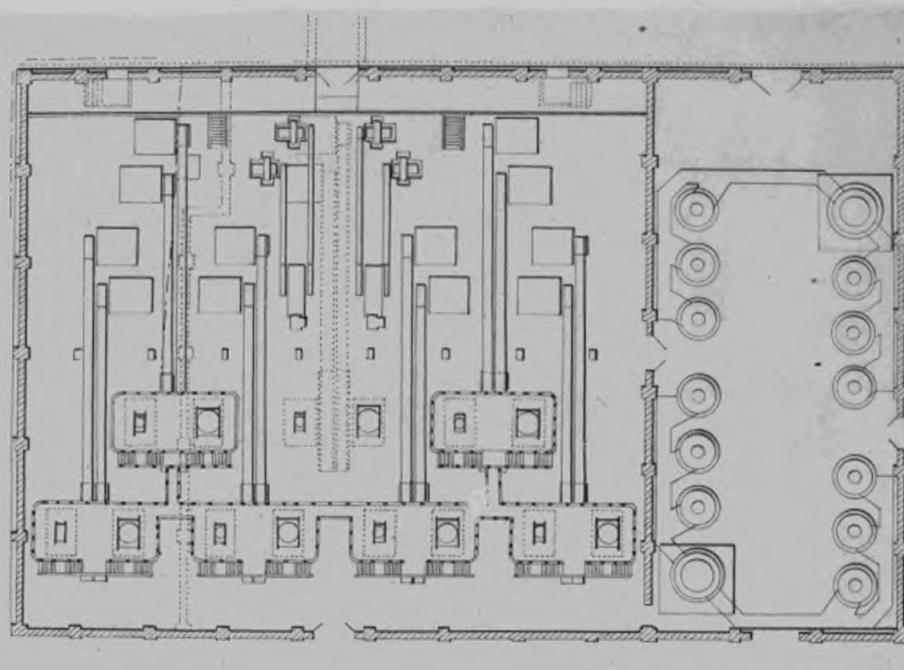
TRAMWAY DE NEW-JERSEY. PLAN DE LA STATION DE FORCE
